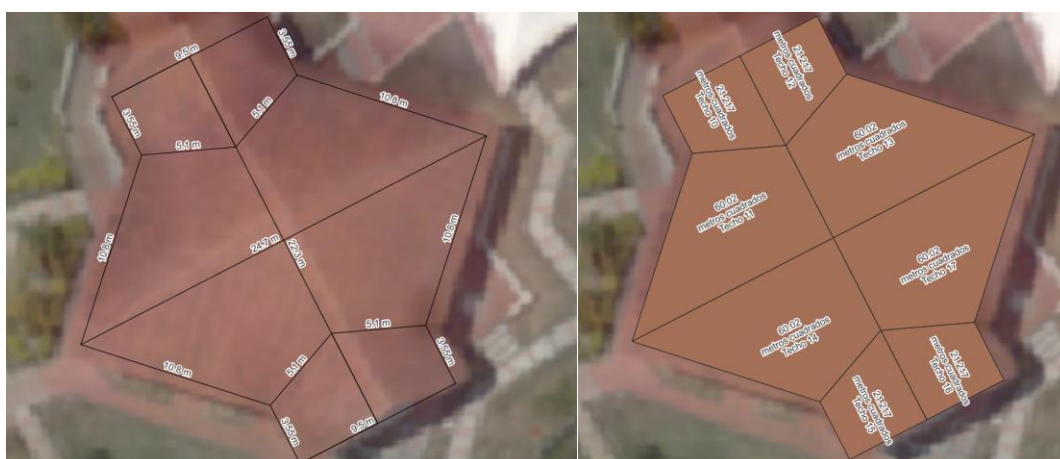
Dimensiones y Área de cubiertas Bloque 3
